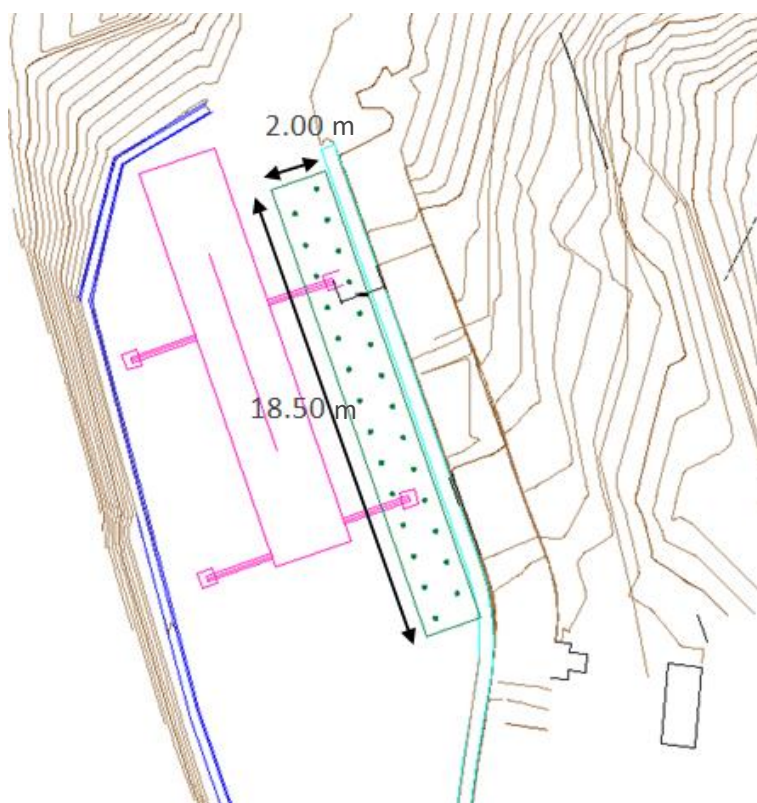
Croquis en planta de la solución de cimentación profunda de los apoyos de la grúa.
